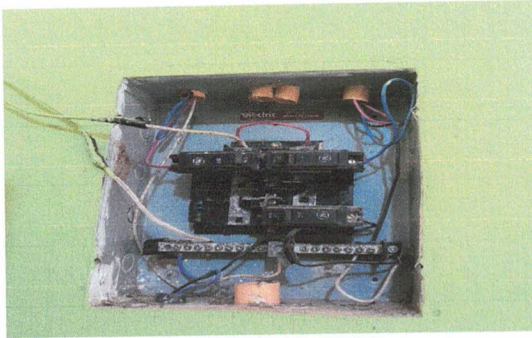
En esta imagen se aprecia el aula número 2, Sustitución del cable eléctrico, tomacorrientes e interruptores en planta baja
